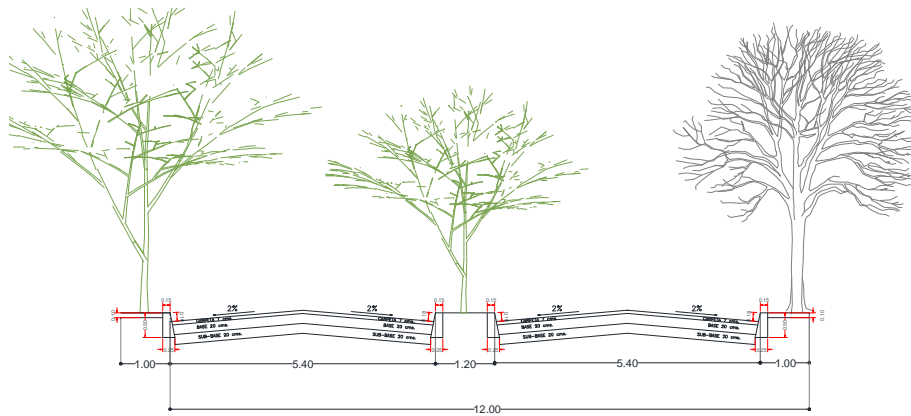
Estructura de Pavimento de Vialidad Principal.
